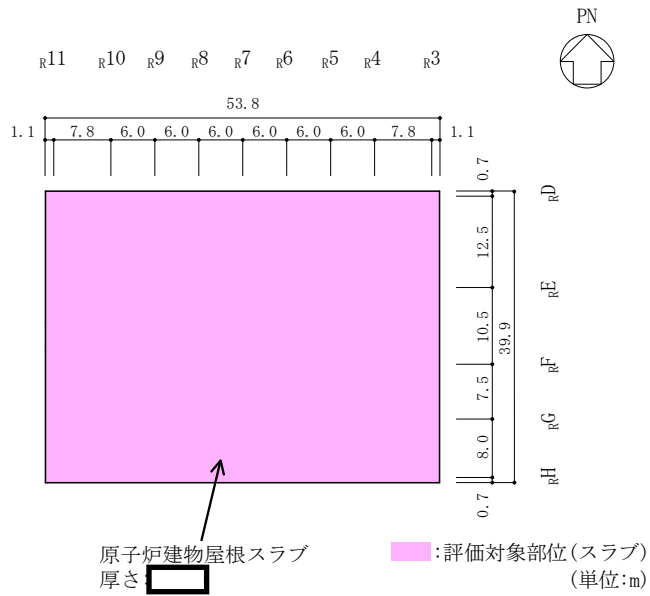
(2) 原子炉建物の概略平面図 (EL 63.5m)
